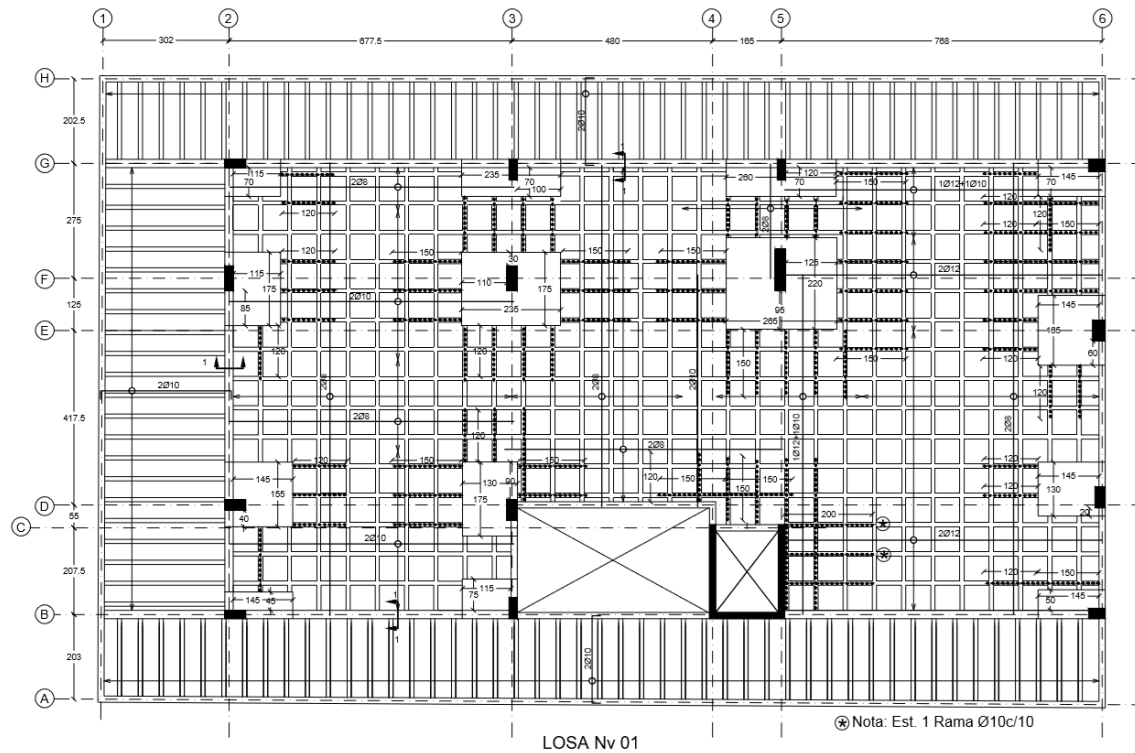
Plano estructural losa de Planta Baja Nv 01 [12]
